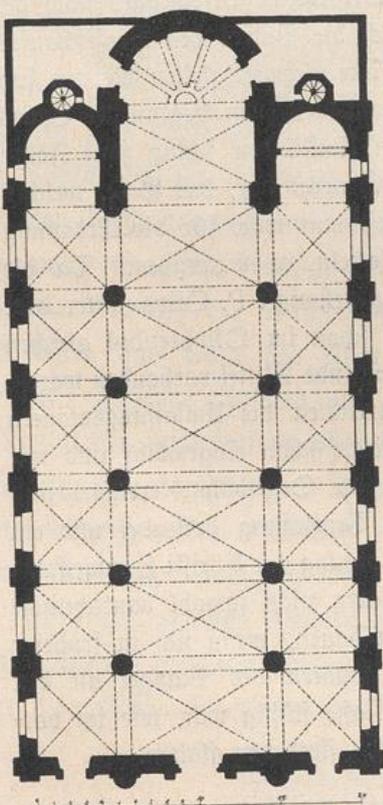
Mecheln. Frühere Jesuitenkirche. Grundriß.
